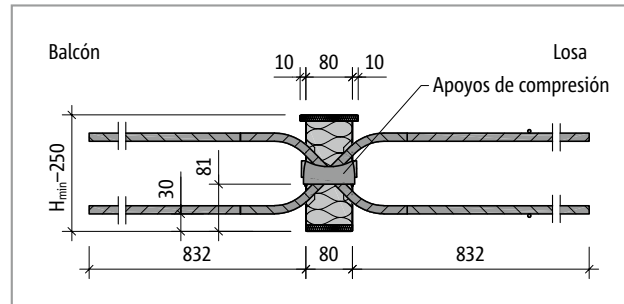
Schöck Isokorb® T tipo Q-VV12: Sección del producto
